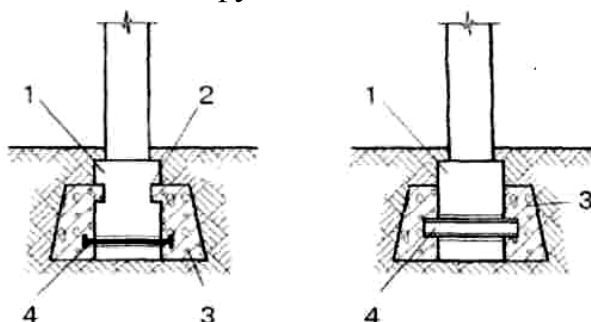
Схема підсилення фундаментів залізобетонними обоймами:
